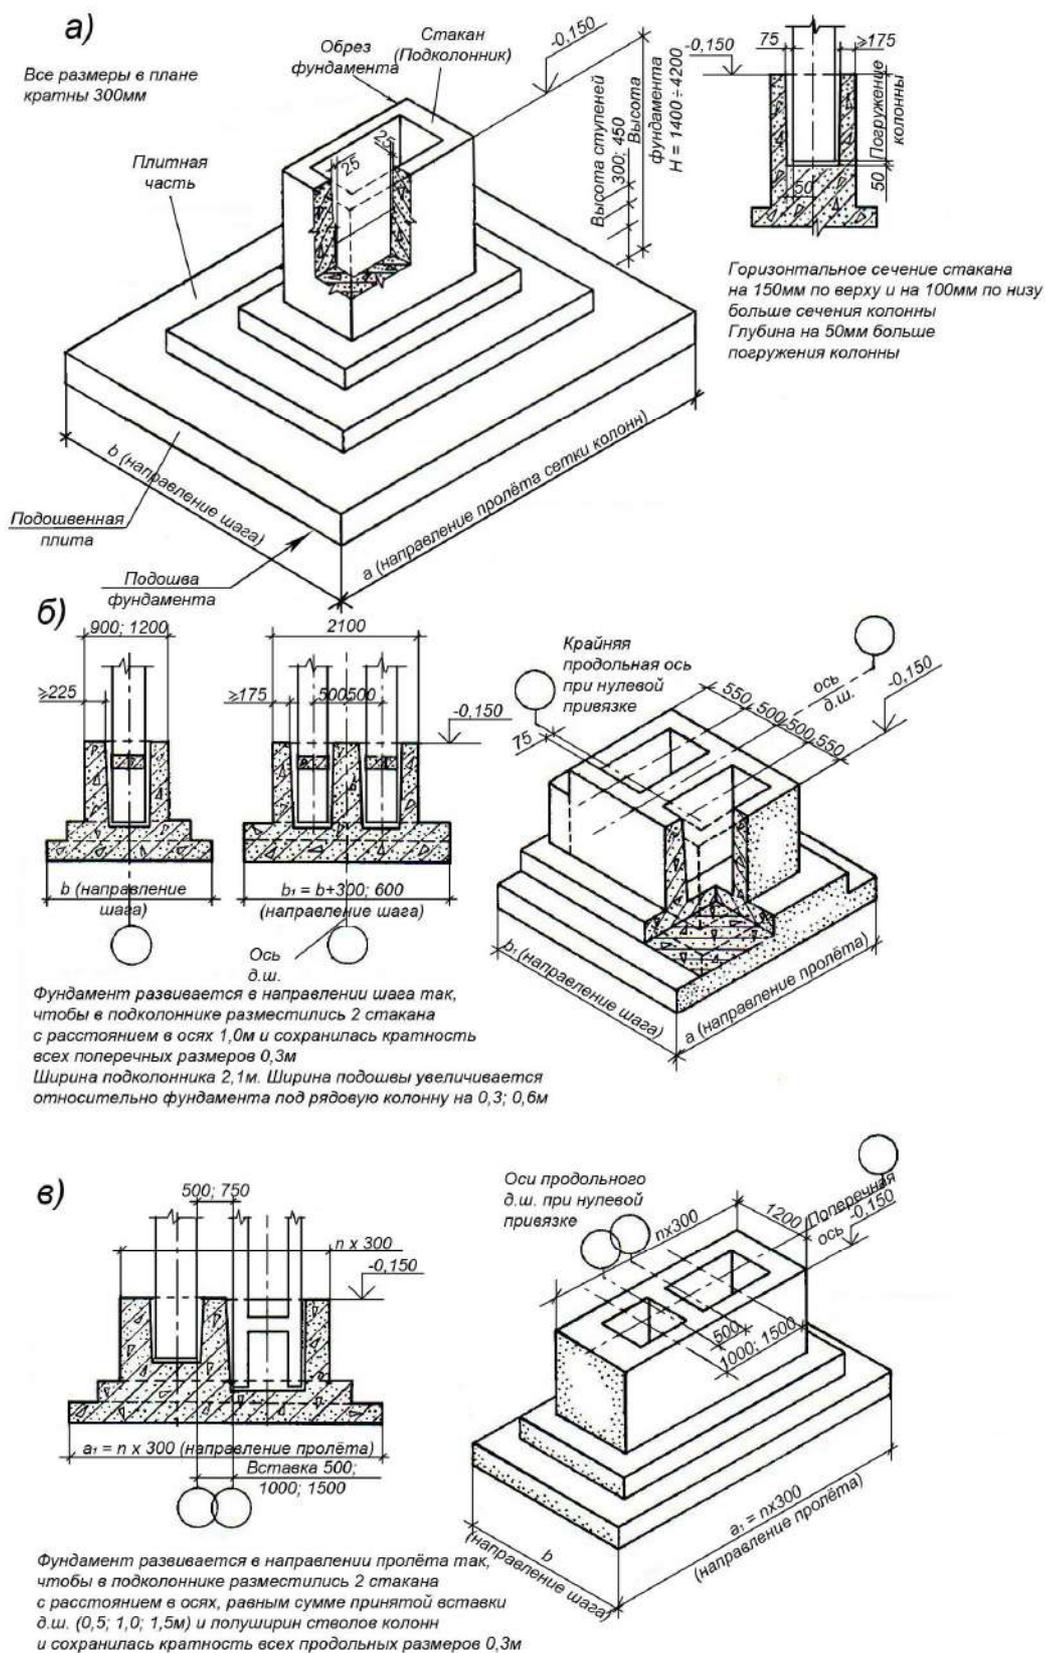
Монолитные железобетонные фундаменты под железобетонные колонны:
